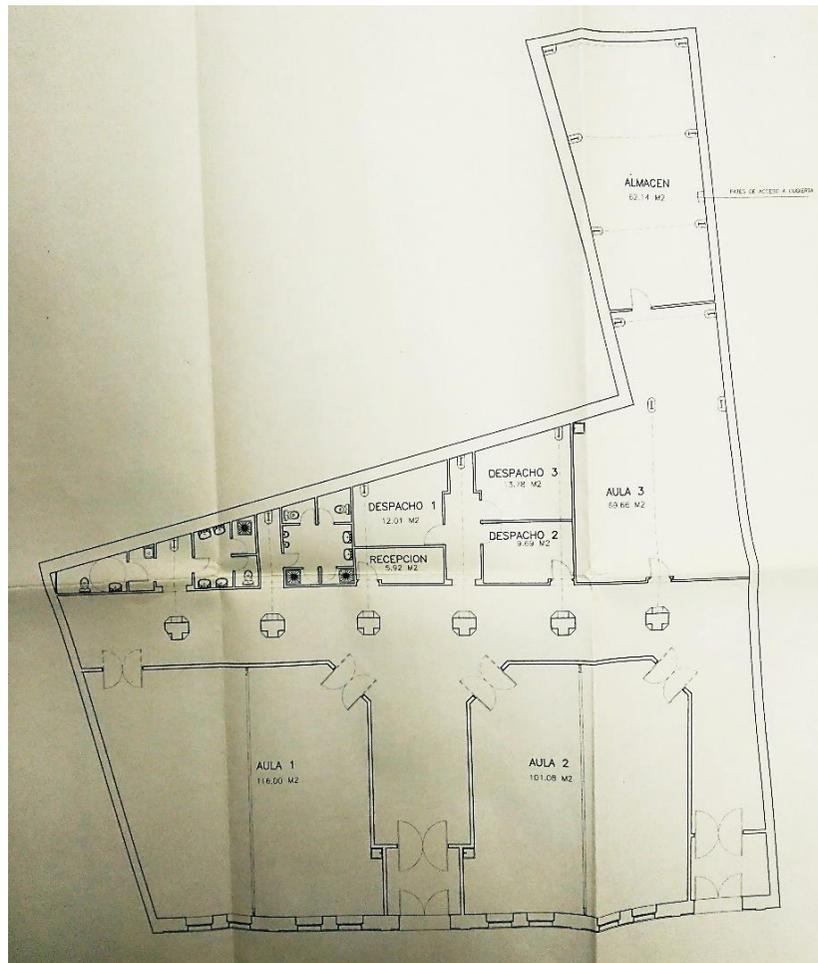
Planta de arquitectura del proyecto de la GMU en 1996. Redistribuye la nave con una tabiquería que separa zonas de trabajo para la escuela taller y la creación de oficinas y almacenes en la parte posterior. Fuente: GMU
